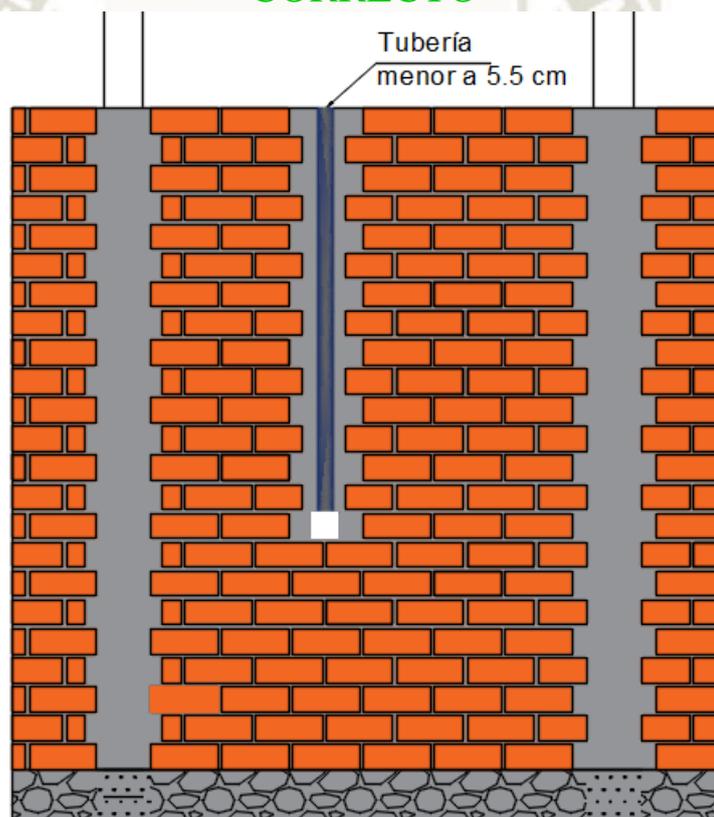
Correcta colocación de tuberías menores a 5.5 cm.
